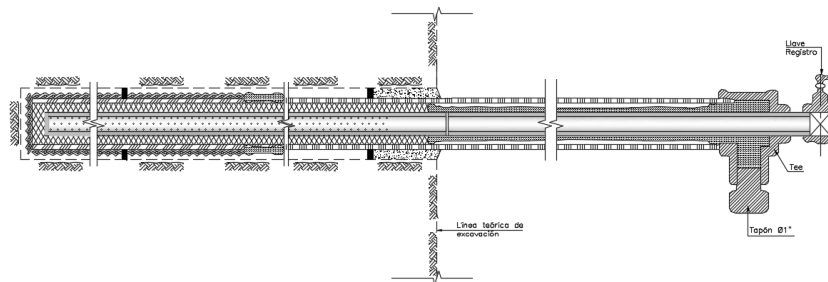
Sistema Antiavalancha utilizado en los drenajes.
